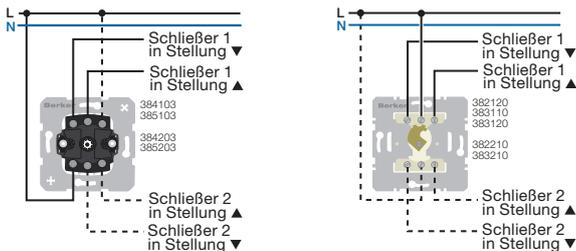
Jalousie-Drehschalter 1- und 2-polig [Best.-Nr. 3841 03, 3842 03]; Jalousie-Schalter 1- und 2-polig für Zentralstück mit Schloss [Best.-Nr. 3851 03, 3852 03] / Jalousie-Schalter/-Taster 1- und 2-polig für Schließzylinder [Best.-Nr. 382..., 383..]
